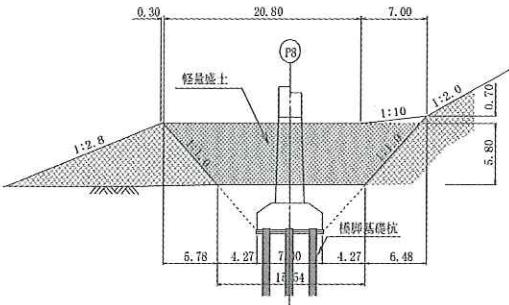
既設橋脚周辺の嵩上げ盛土の断面図
